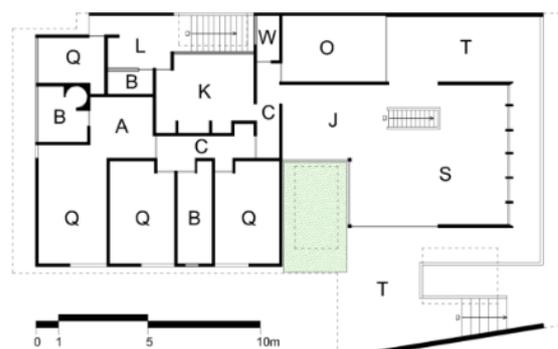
Planta Baixa Pavimento Superior. Fonte: Croqui da autora.
